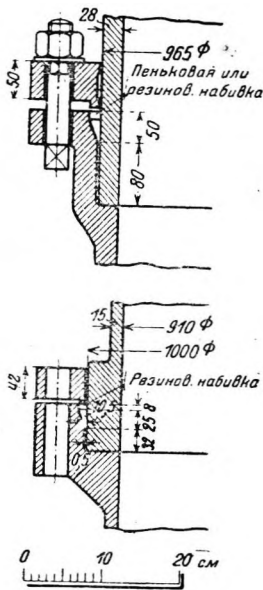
Бьельво. Напорный трубопровод. Продольный разрез.
